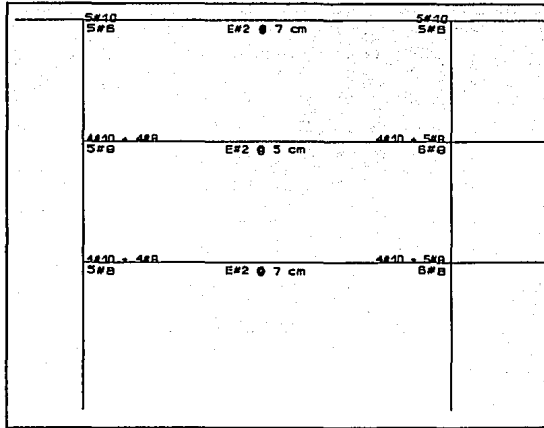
Armados en las vigas del eje 2, modelo 1 (Q=2)
